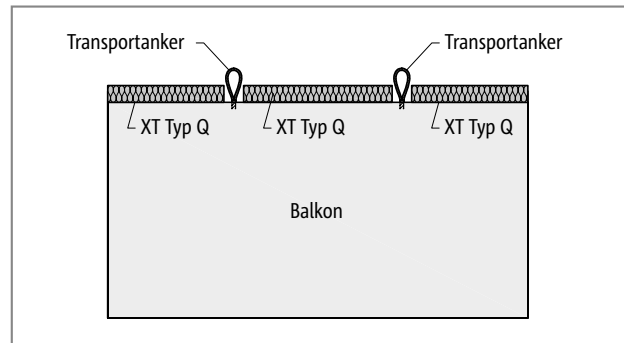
Schöck Isokorb® XT Typ Q: Elementbalkon mit Transportanker; Dämmzwischenstück XT Typ Z kann bauseitig eingelegt werden
